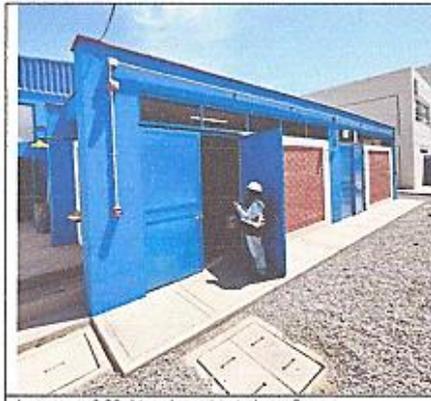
Vereda perimetral con fisuras
